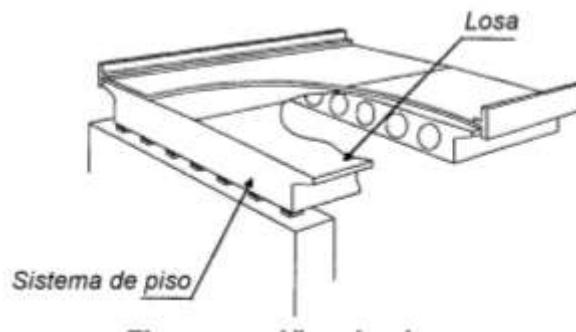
Viga tipo losa. Fuente: Manual de Puentes MOPT, 2007
